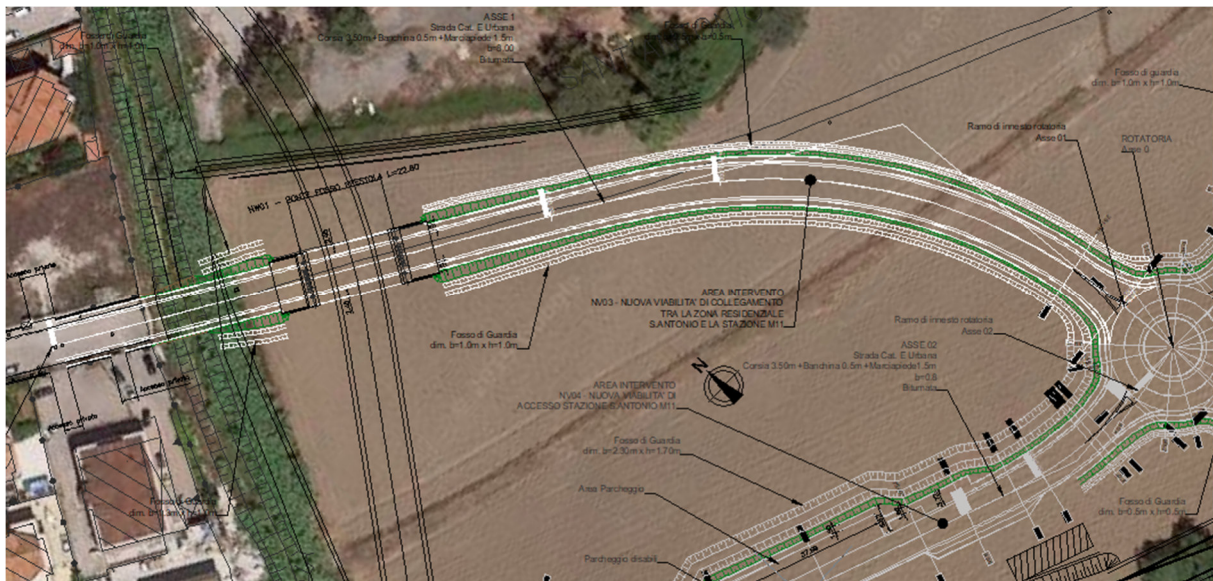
Stralcio planimetrico – NV03_Nuova viabilità di collegamento tra la zona residenziale S. Antonio e la Stazione M11
